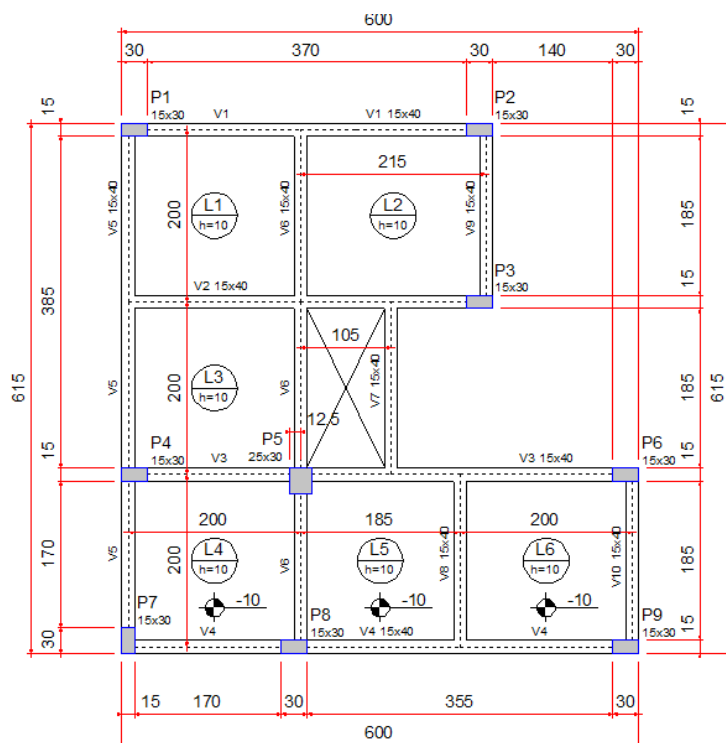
Planta de fôrma esquemática com cotas e nomeação dos elementos estruturais. (Fonte: <https://www.altoqi.com.br>)
